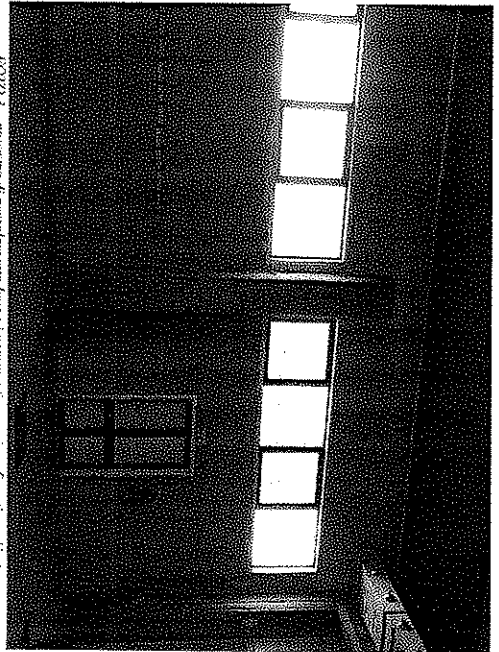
presenza di predeformazione lungo i paramenti murari collegati con il sistema
